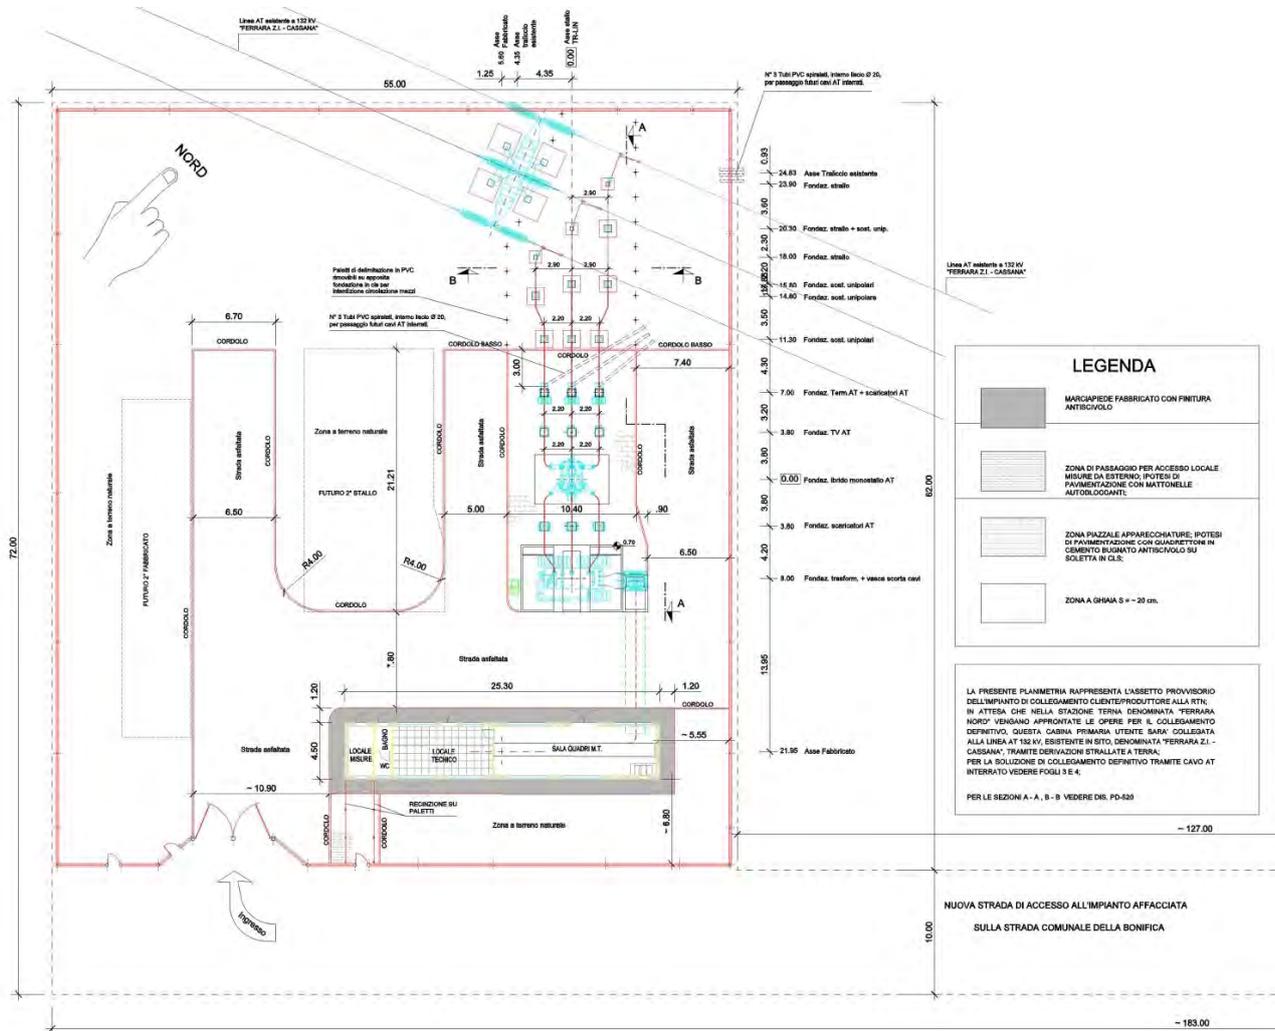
Planimetria cabina primaria e nuovo impianto di collegamento alla RTN
